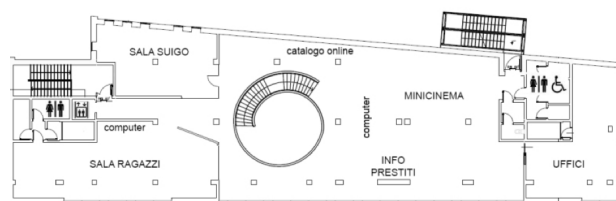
Planimetria piano terra. Fonte: Area Progetti, Torino.
